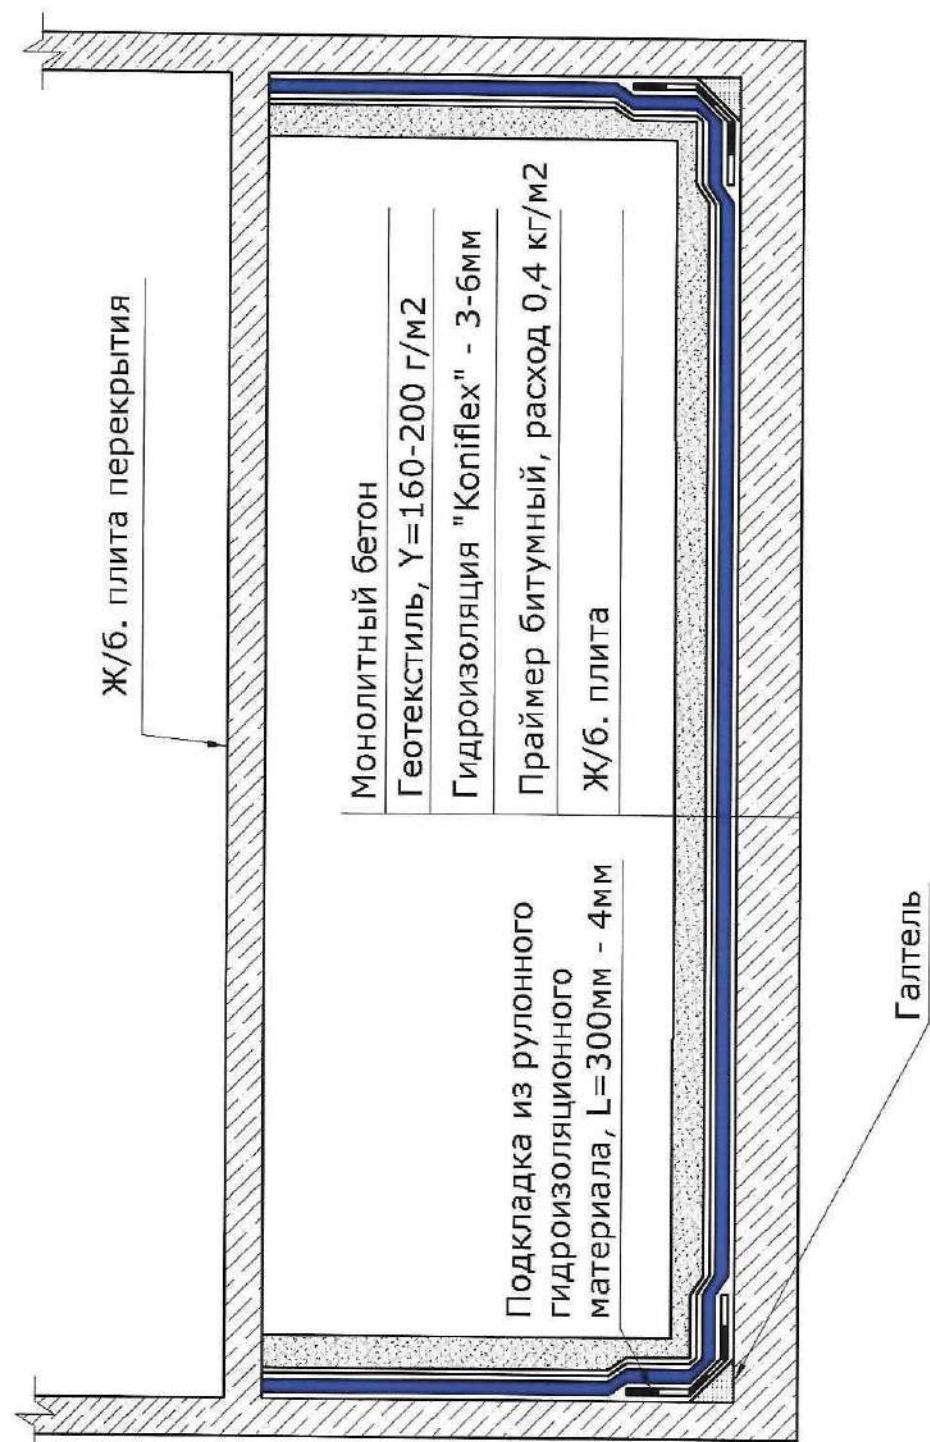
Внешняя гидроизоляция тоннеля.
